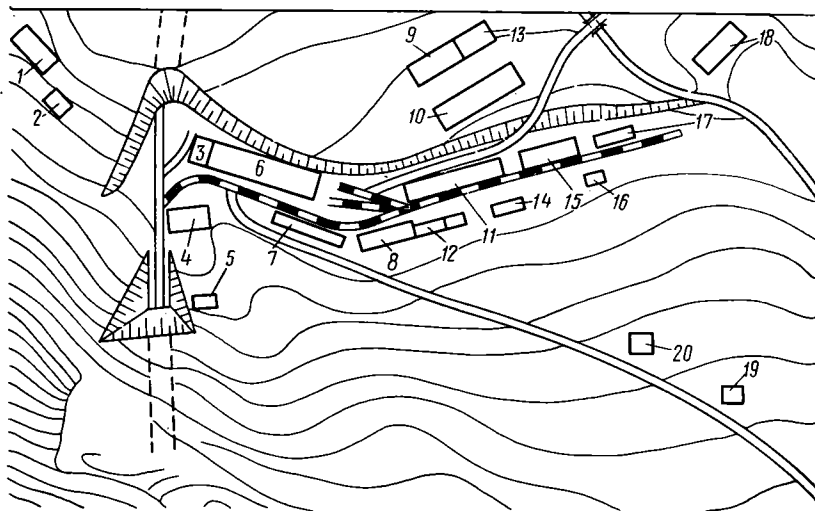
План строительной площадки, расположенной у портала автодорожного тоннеля:
